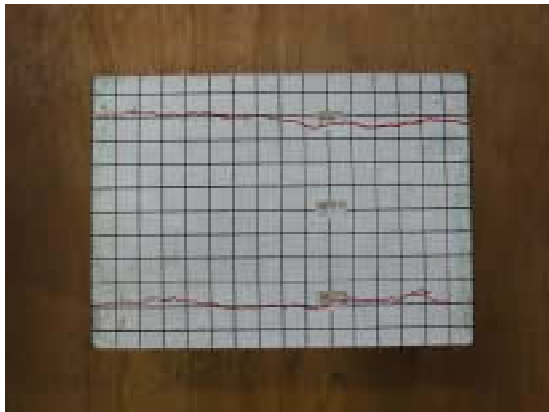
ひび割れ状況（主躯体左側壁外面）
